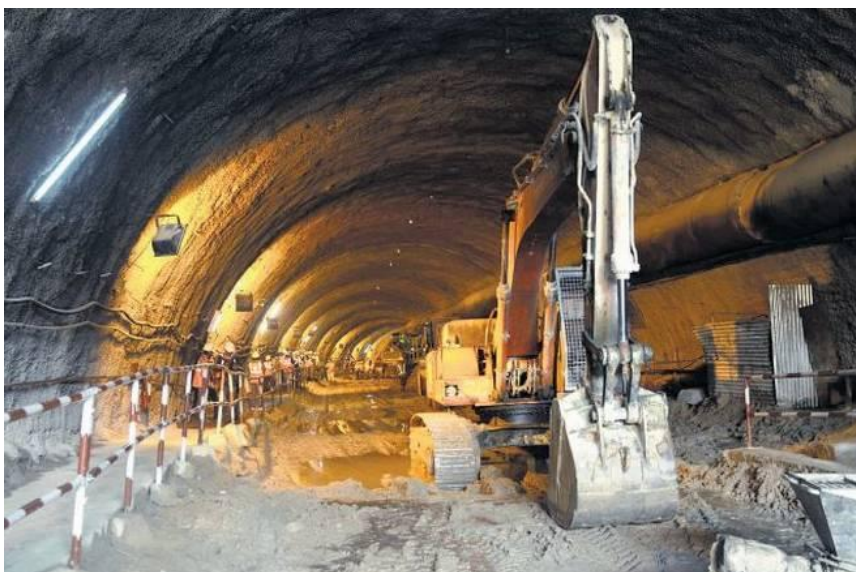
Vista do Interior da Estação Vila Madalena durante escavação
